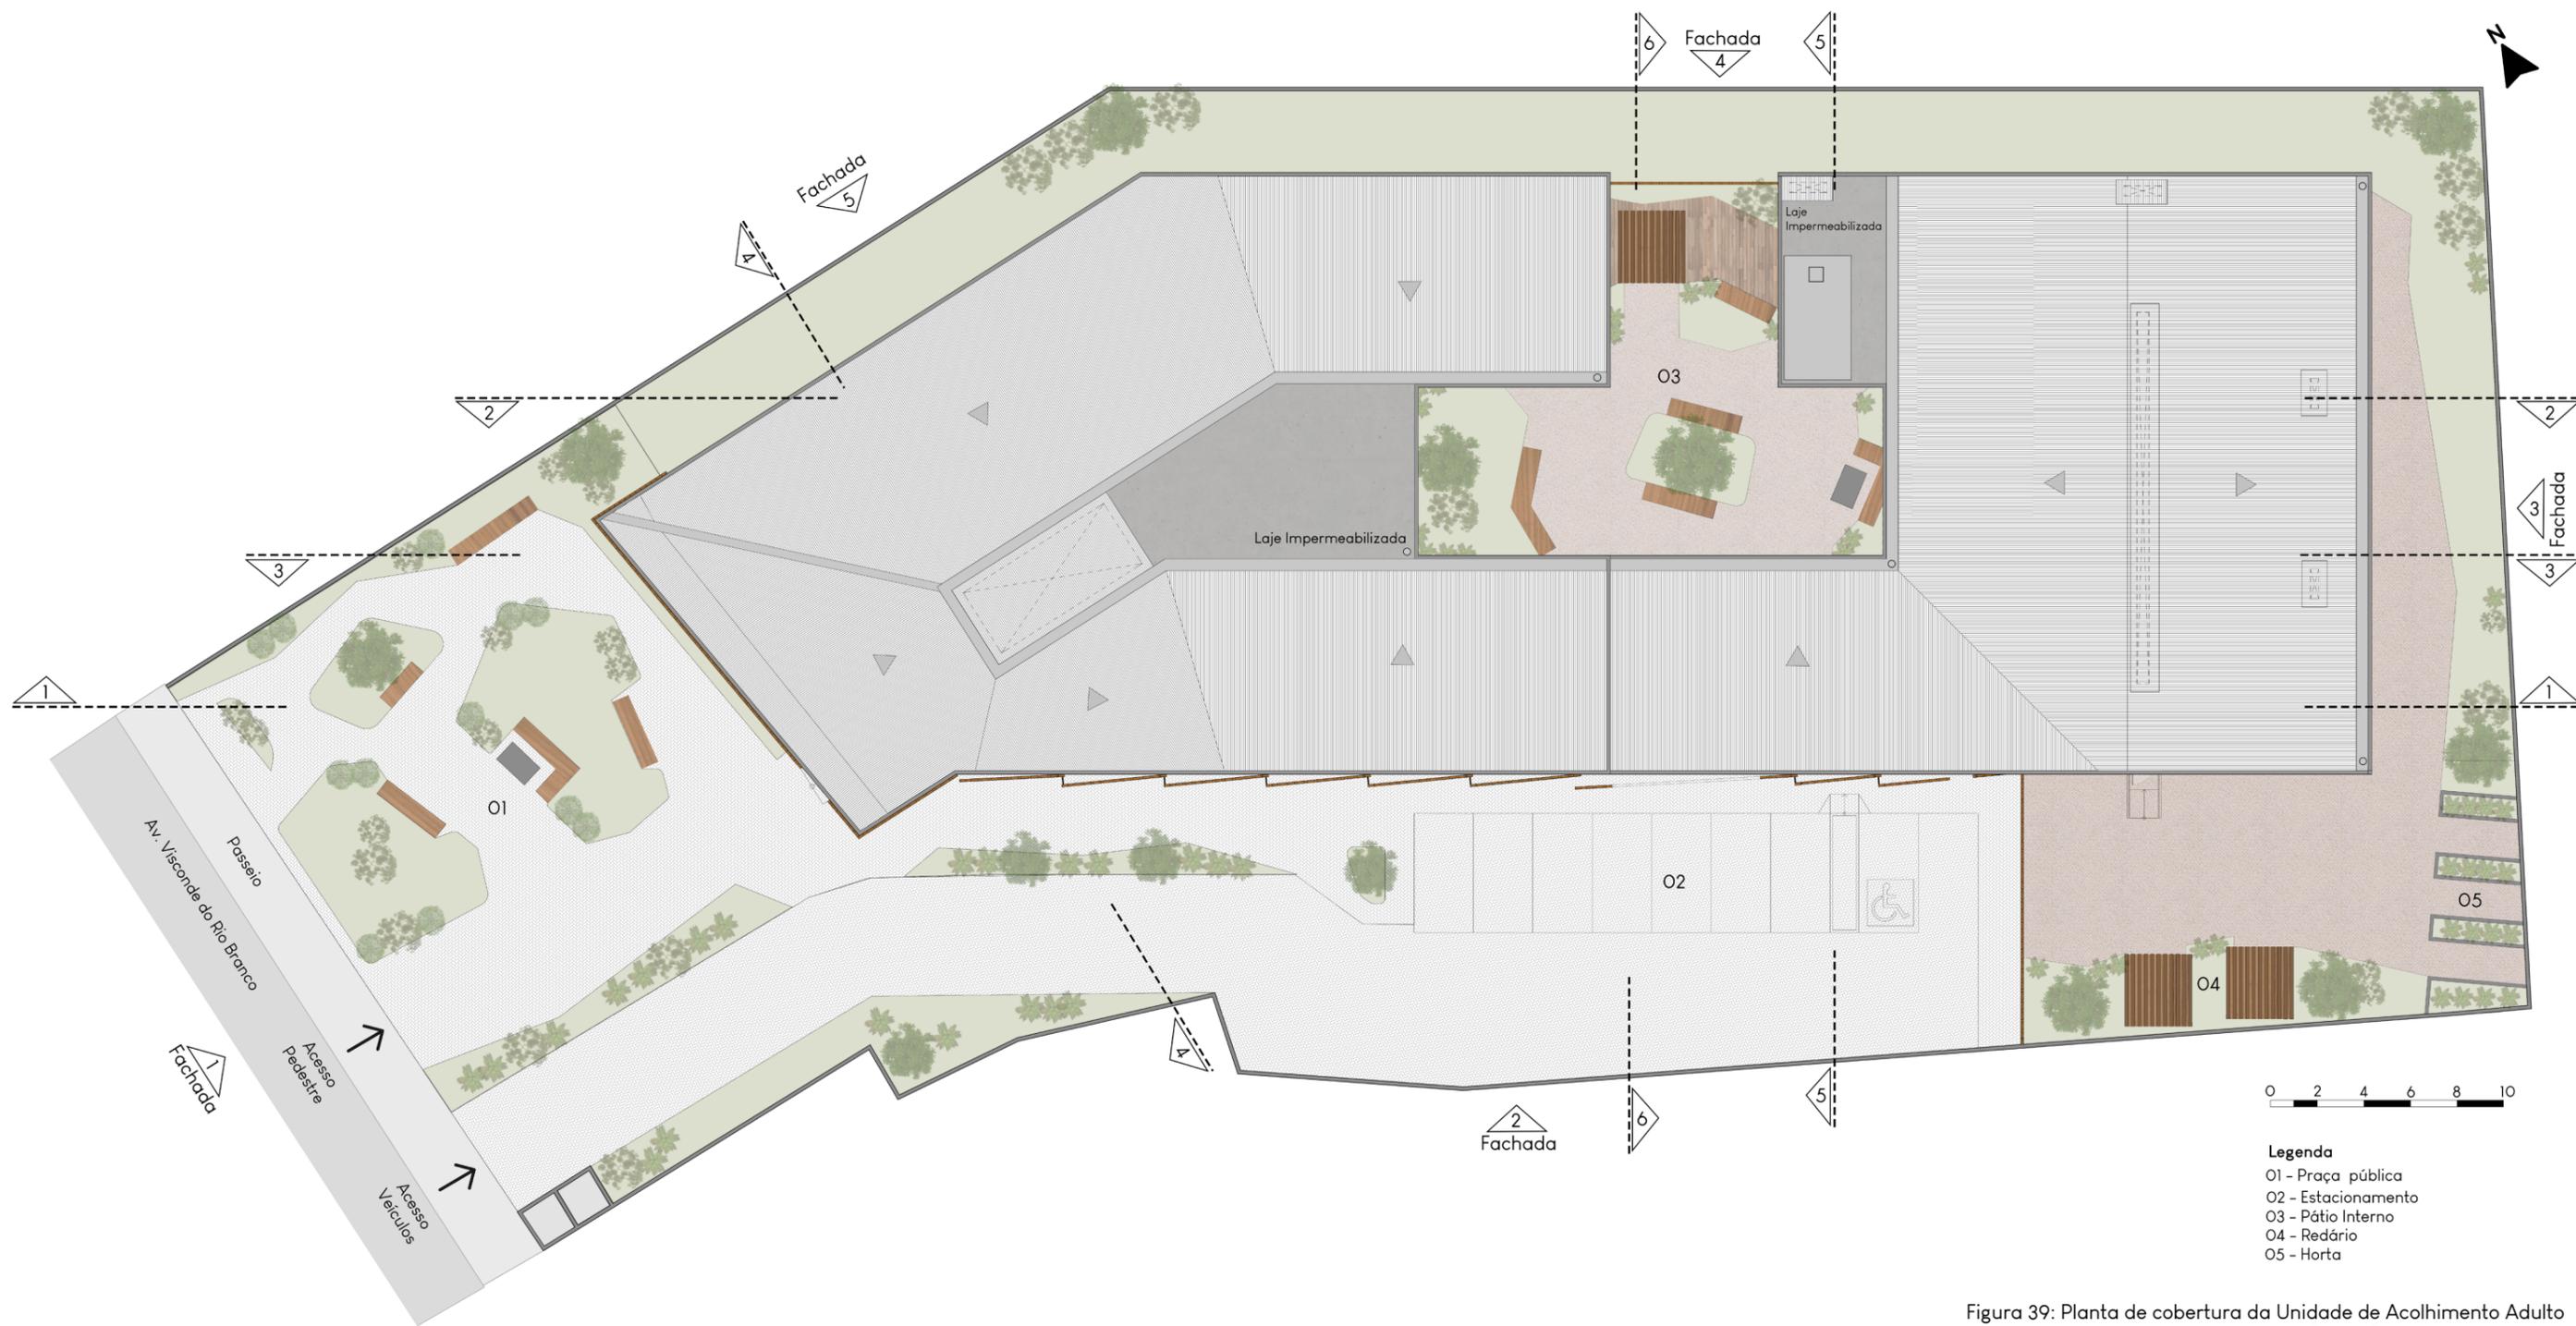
Planta de cobertura da Unidade de Acolhimento Adulto
